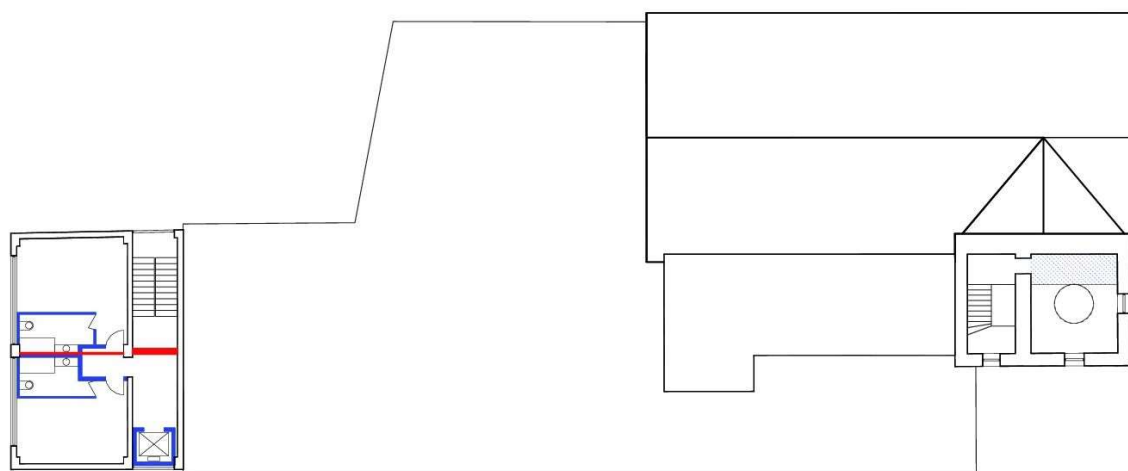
1. kat - shema rušenja i novih konstrukcija
